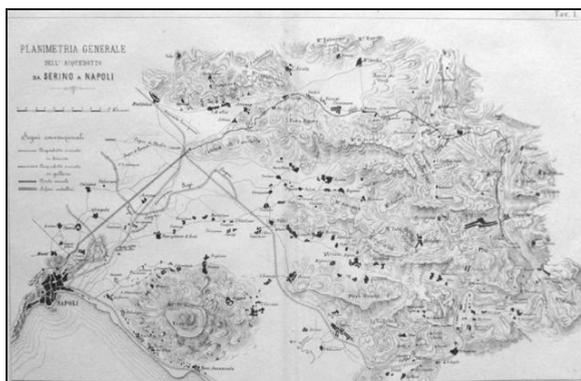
Planimetria generale dell'acquedotto da Serino a Napoli
